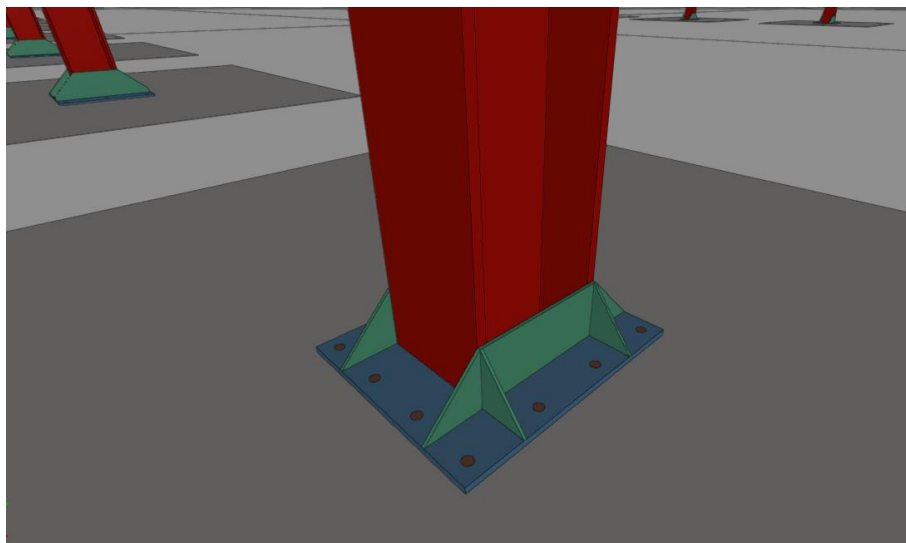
Detalle de cálculo de una zapata y unión
